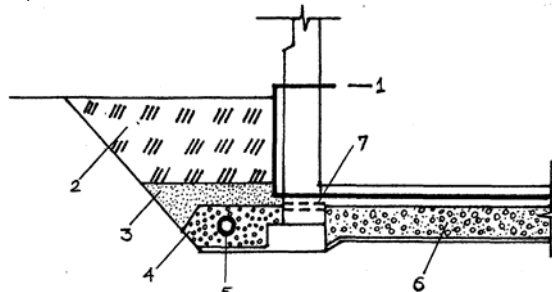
Схема конструкции пластового лощадного дренажа: 1 - гидроизоляция; 2 - местный грунт; 3 - крупнозернистый песок; 4 - гравий или щебень; 5 - труба; 6 - пластовый дренаж; 7 - перепускная труба, наполненная щебнем (гравием)
